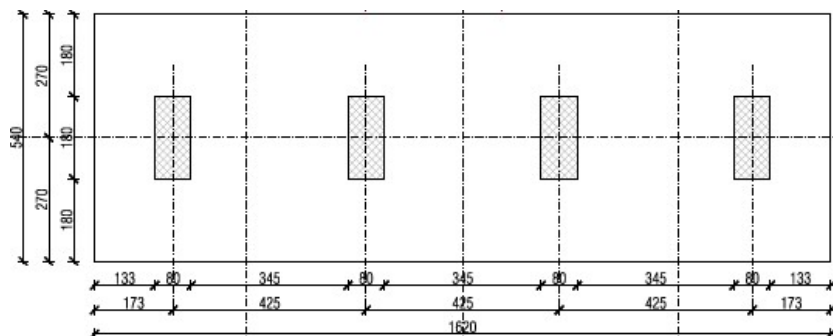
SPALLA CAVALCAVIA CALVECCHIA -PIANTA
